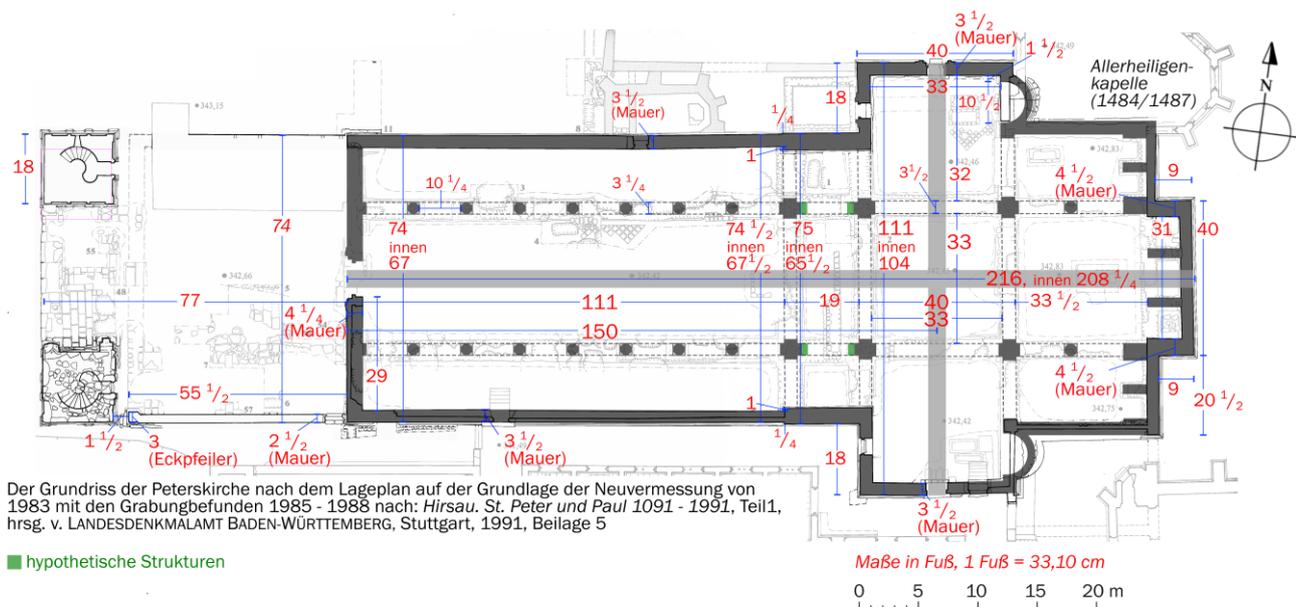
Der rekonstruierte Grundriss der Peterskirche
